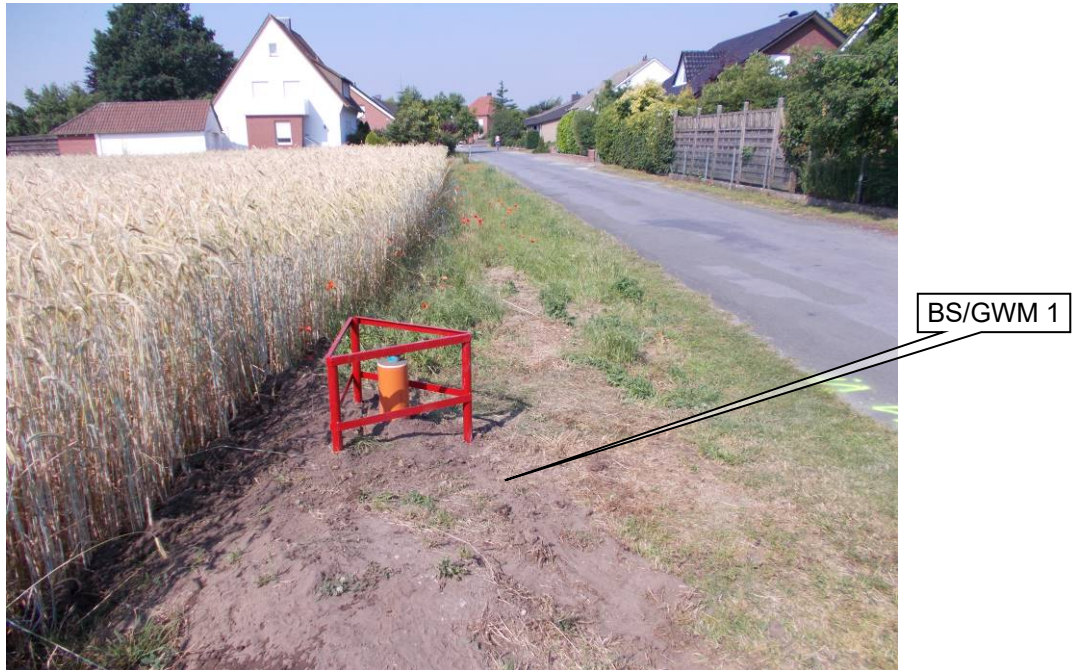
Blickrichtung ~W; Bereich der BS/GWM 1 (Markierung)
